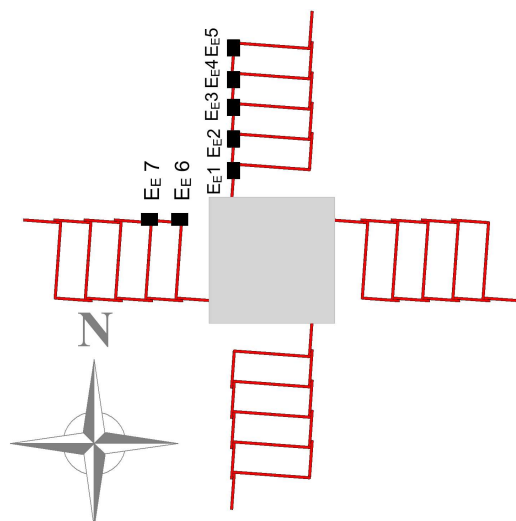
Vista em planta com o posicionamento dos extensômetros nos estribos
